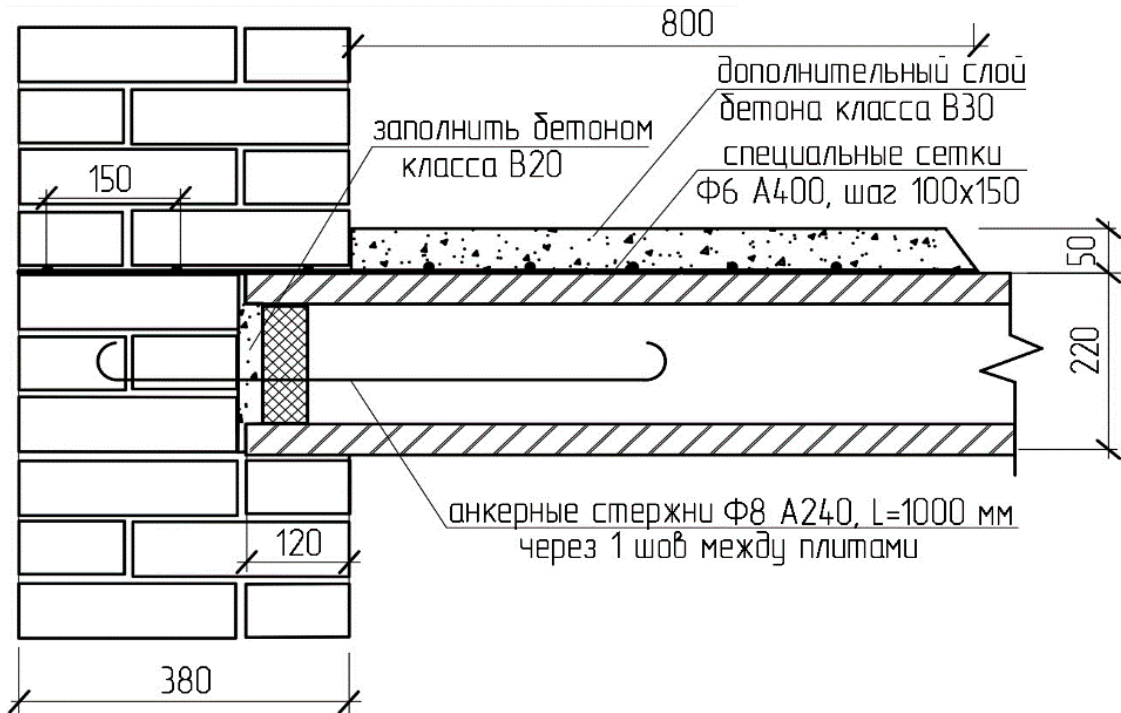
Усиление опорной зоны плиты дополнительной арматурой
